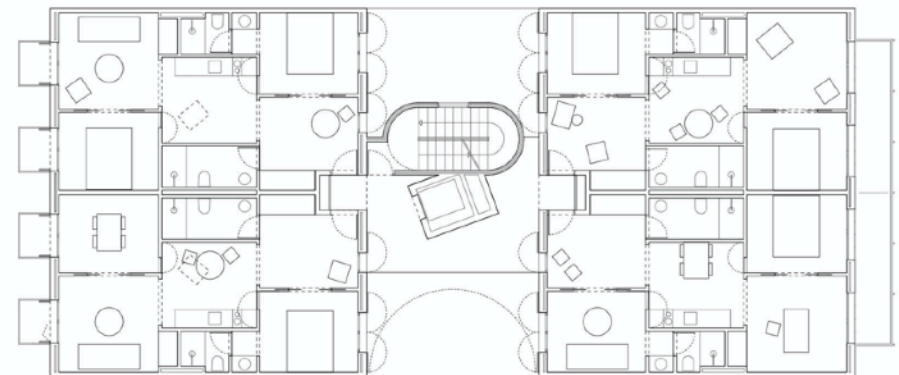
Planta tipo 110 Rooms; MAIO Architects
